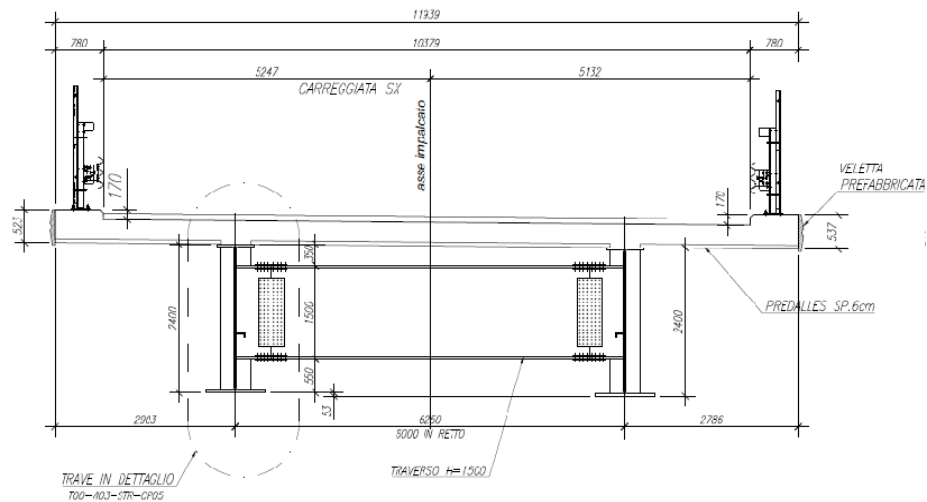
Sezione trasversale impalcato Viadotto sul fiume Merse
